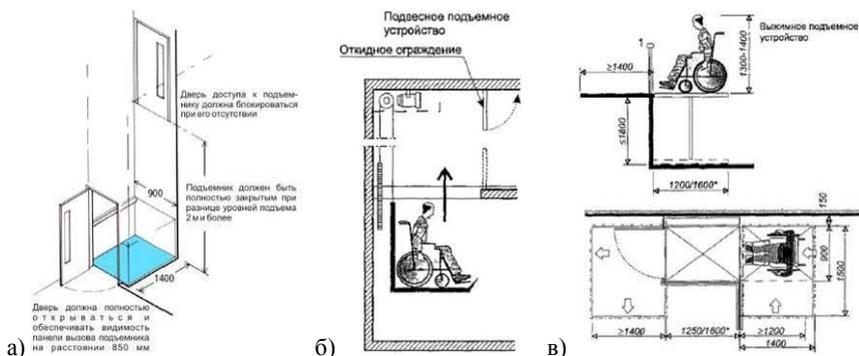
Общий вид и основные размеры подъемников с вертикальным перемещением (а, б – подвесные, в – выжимные)
